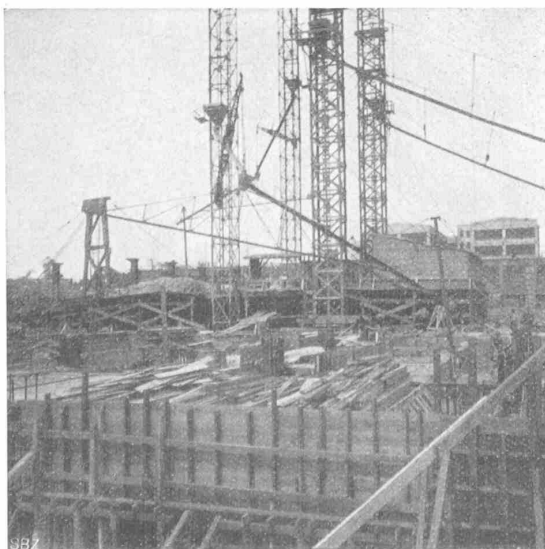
Gussbeton-Verteilanlage eines Eisenbeton-Bauwerks.
